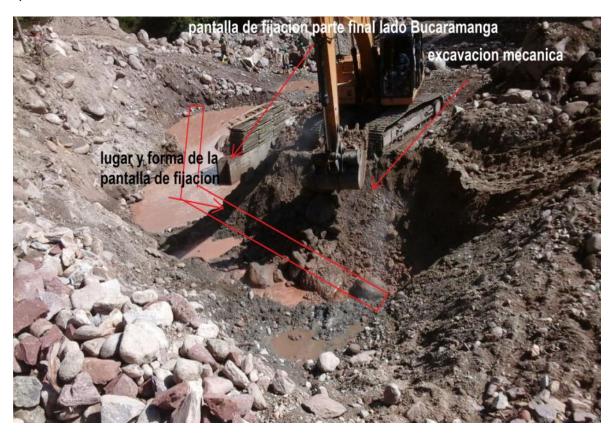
Excavación mecánica de muero en concreto ciclópeo.
